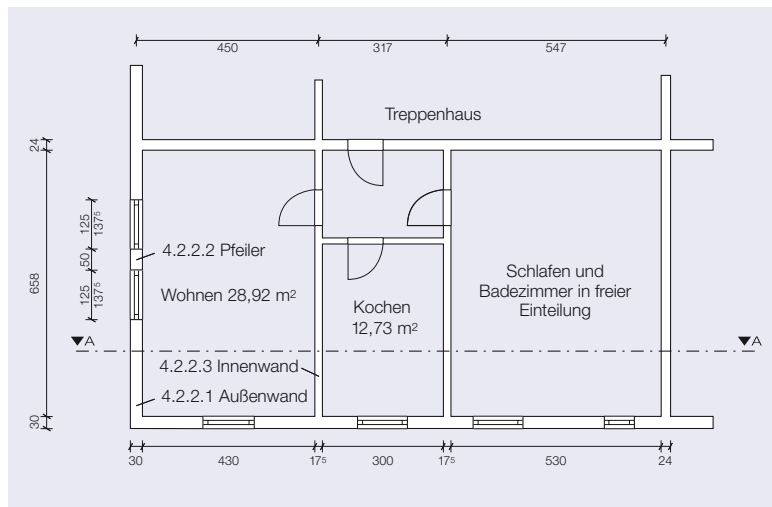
Grundriss Wohnung [Maße in cm]
